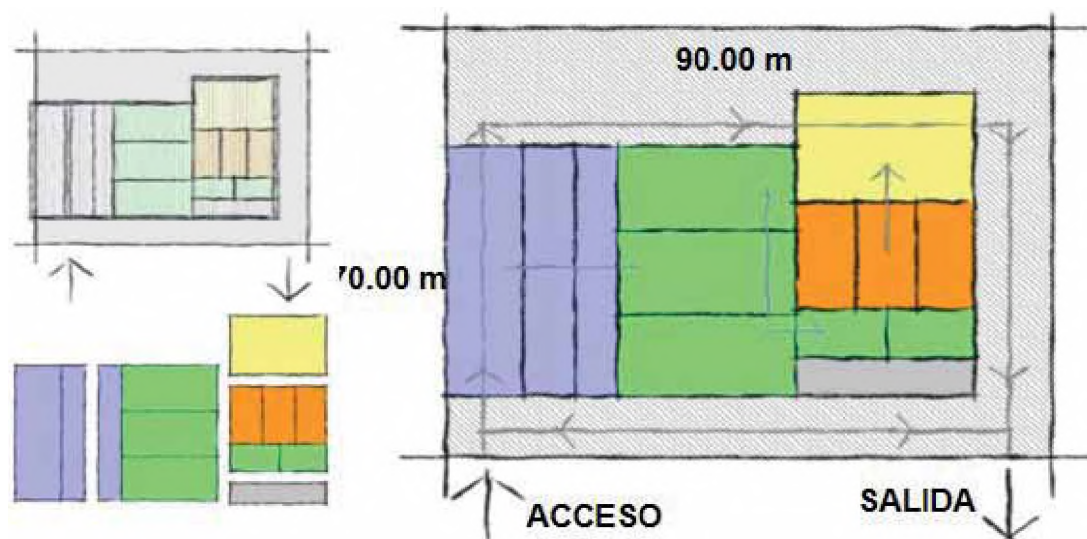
Esquemas en planta de alternativa 1. Fuente: elaboración propia
